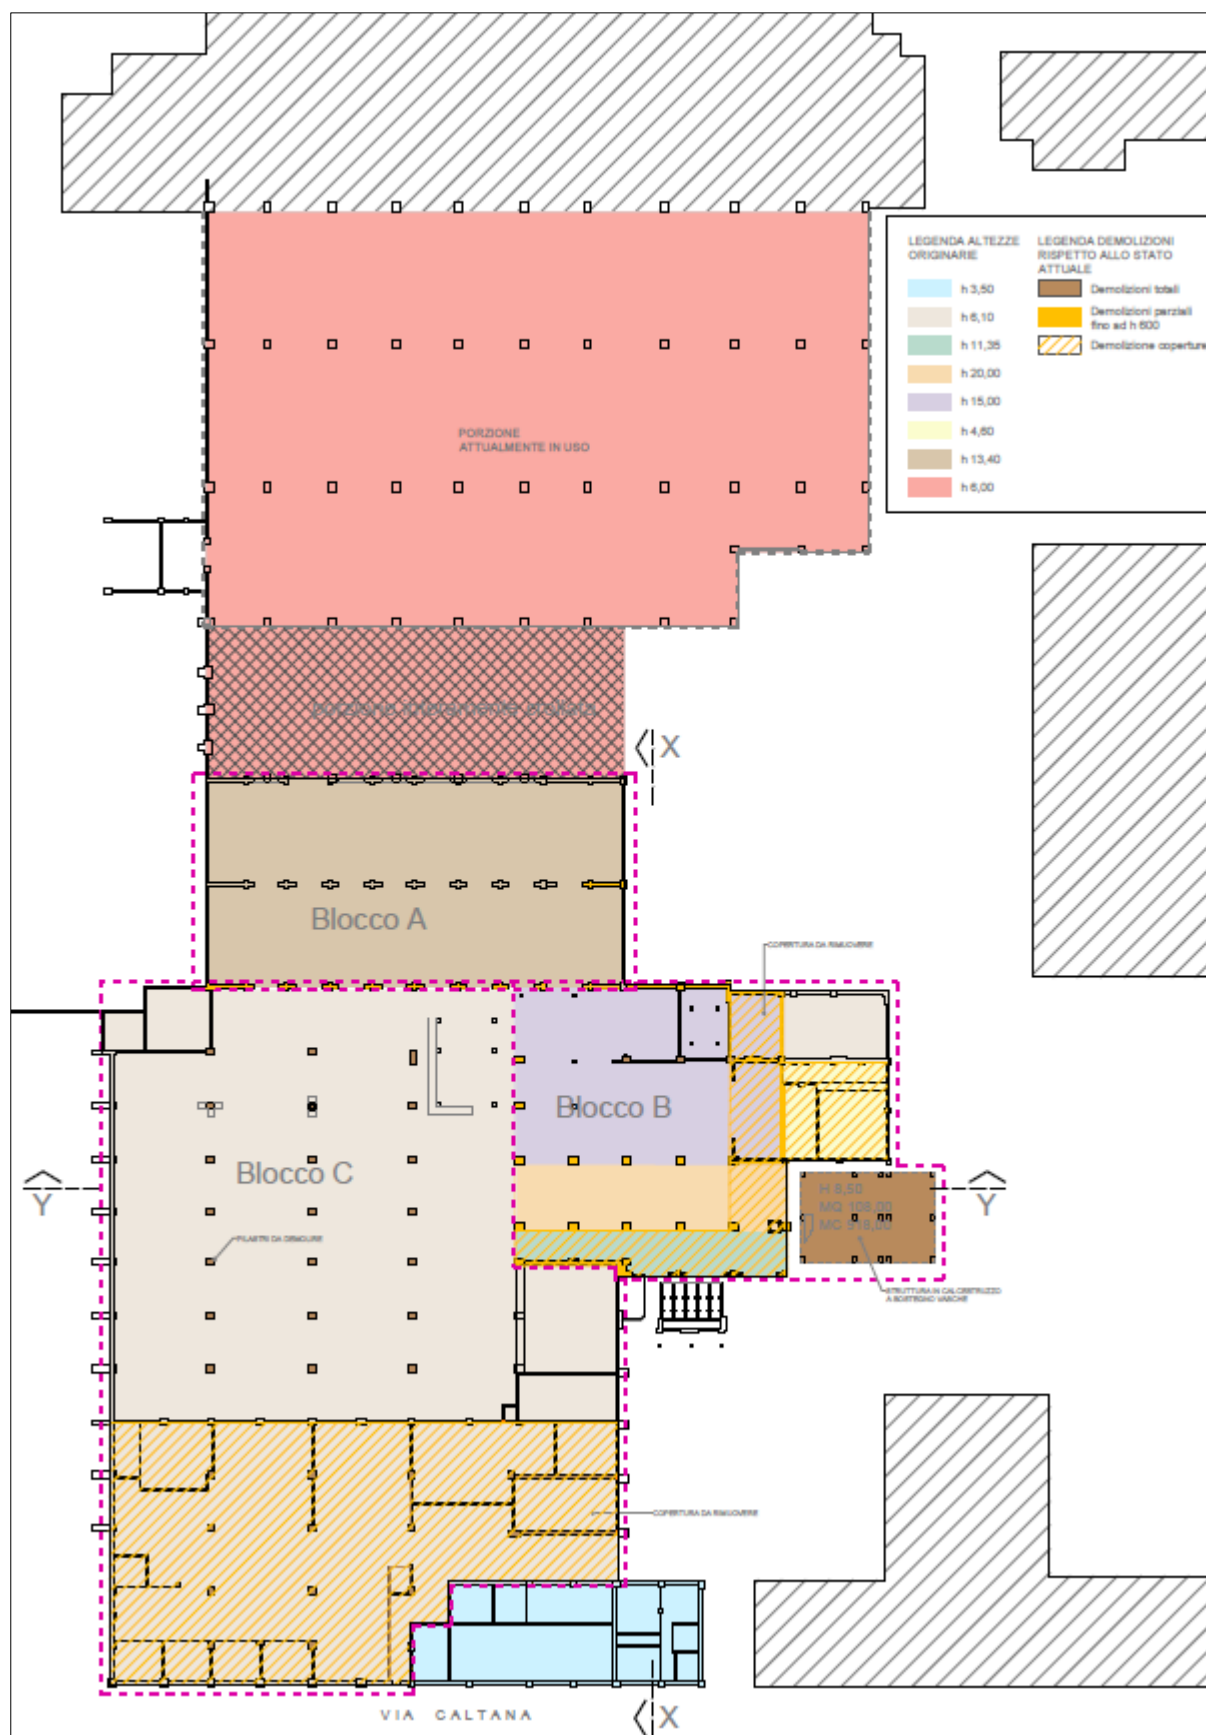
Pianta dello stato di fatto con evidenziate le zone oggetto di demolizione totale o parziale
